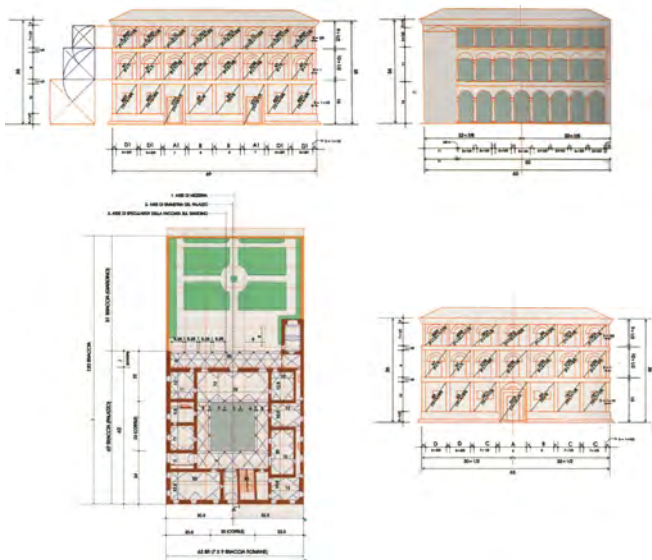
Pianta, prospetti e sezione di Palazzo Piccolomini, ipotesi ricostruttiva.
